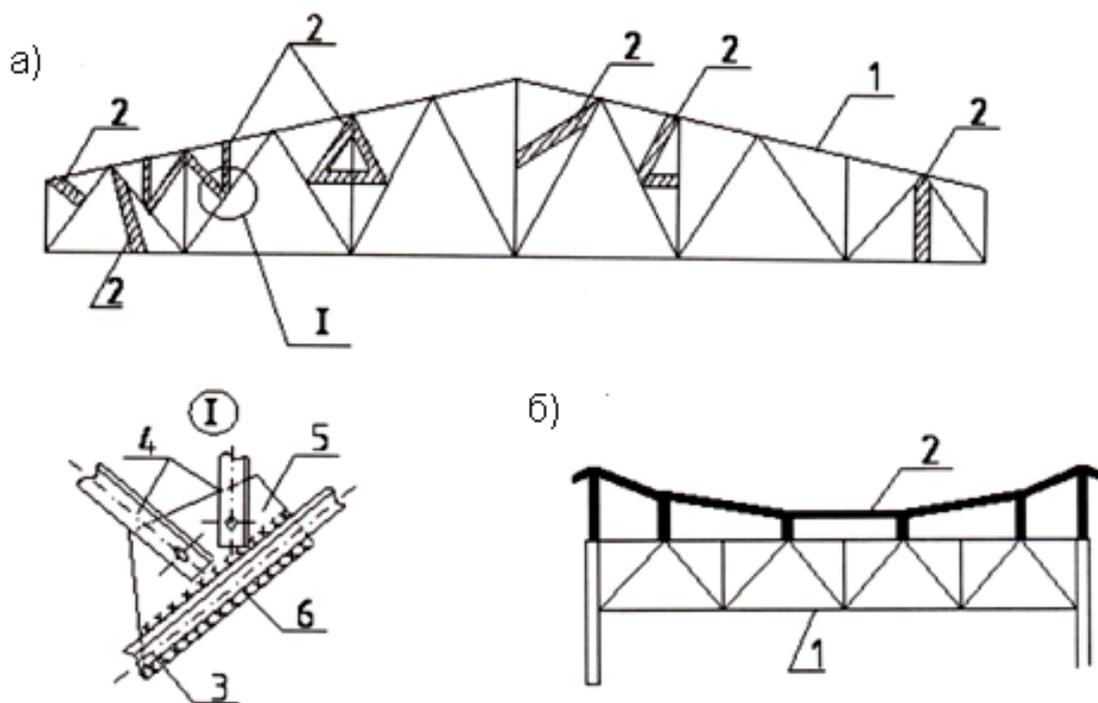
Схемы усиления ферм за счет изменения конструктивной схемы:
